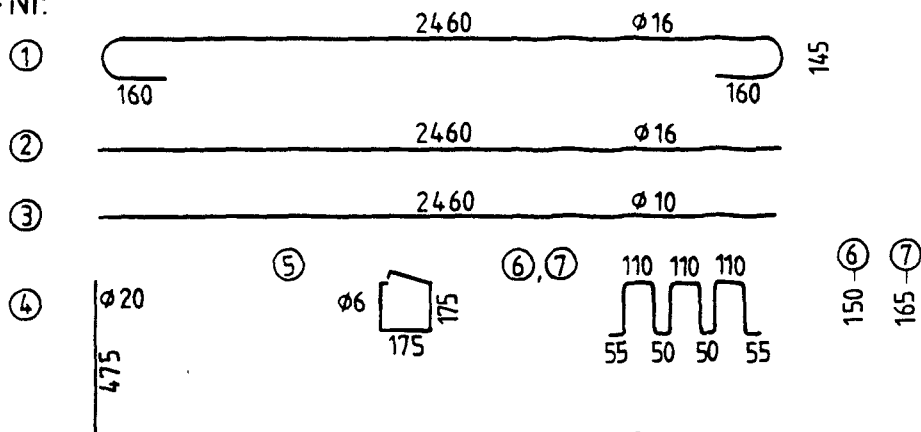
Bewehrungsführung, Prüfkörper P 1,5 - o/mB
